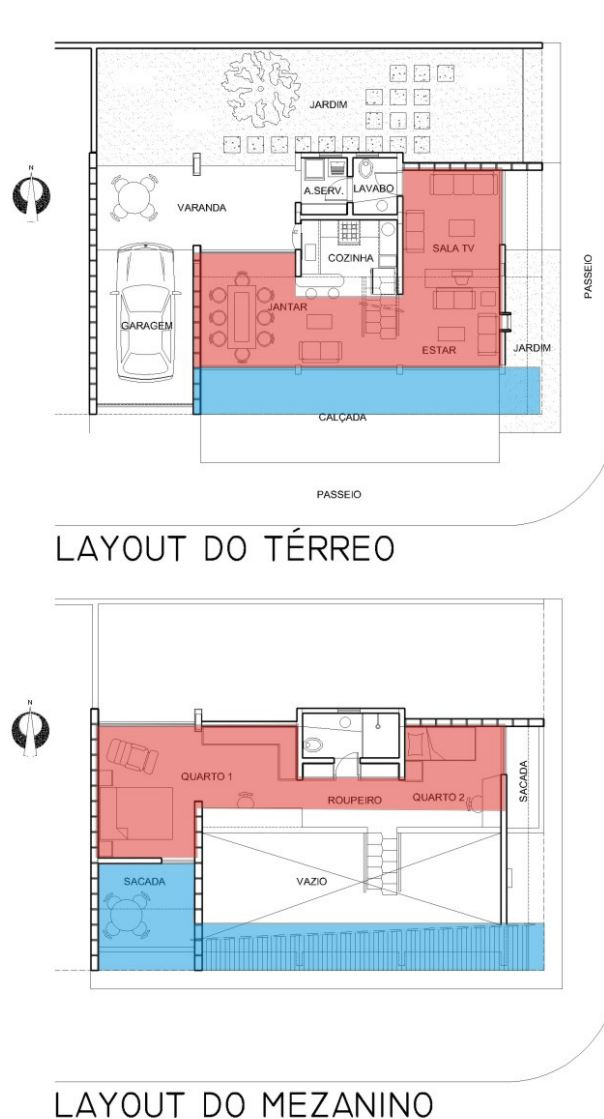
Projeto 2 - Setorização e Beirais - Plantas
